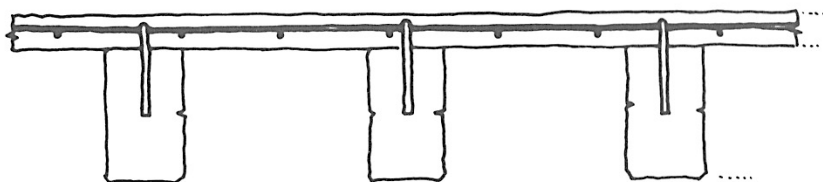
Solução mista de madeira com betão armado. Arriaga [1]
